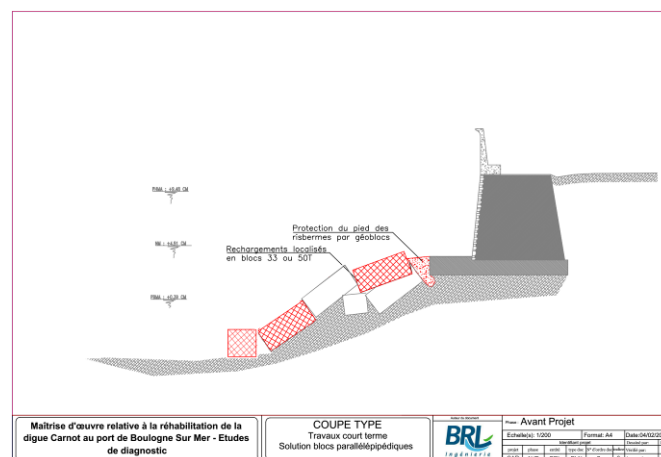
COUPE DE PRINCIPE DES TRAVAUX DE GROS ENTRETIEN - SOURCE : BRL INGENIERIE
